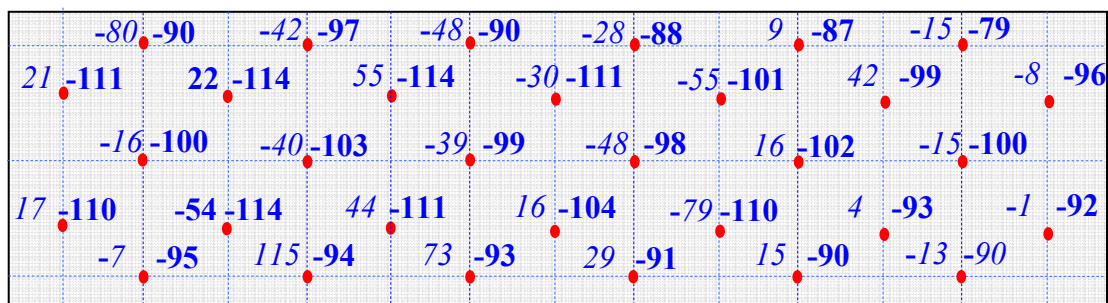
Potenciais de corrosão na face da viga V7.
